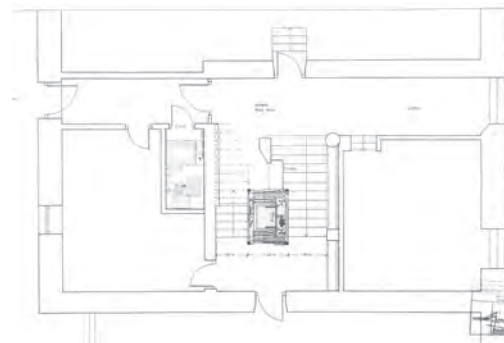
40. PLANTA BAJA. ESTADO REFORMADO
